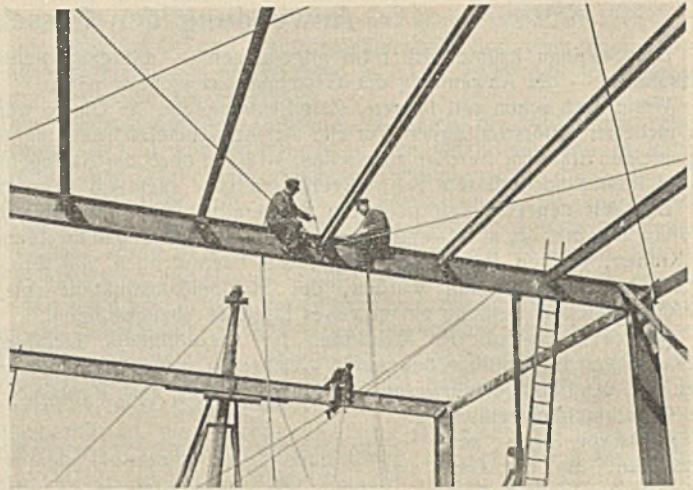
Doppelseitiges Einschweißen der Pfetten.
